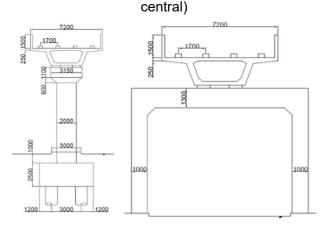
Sección transversal (cuando justo debajo de la viga es carretera y no se puede levantar el pilar)
